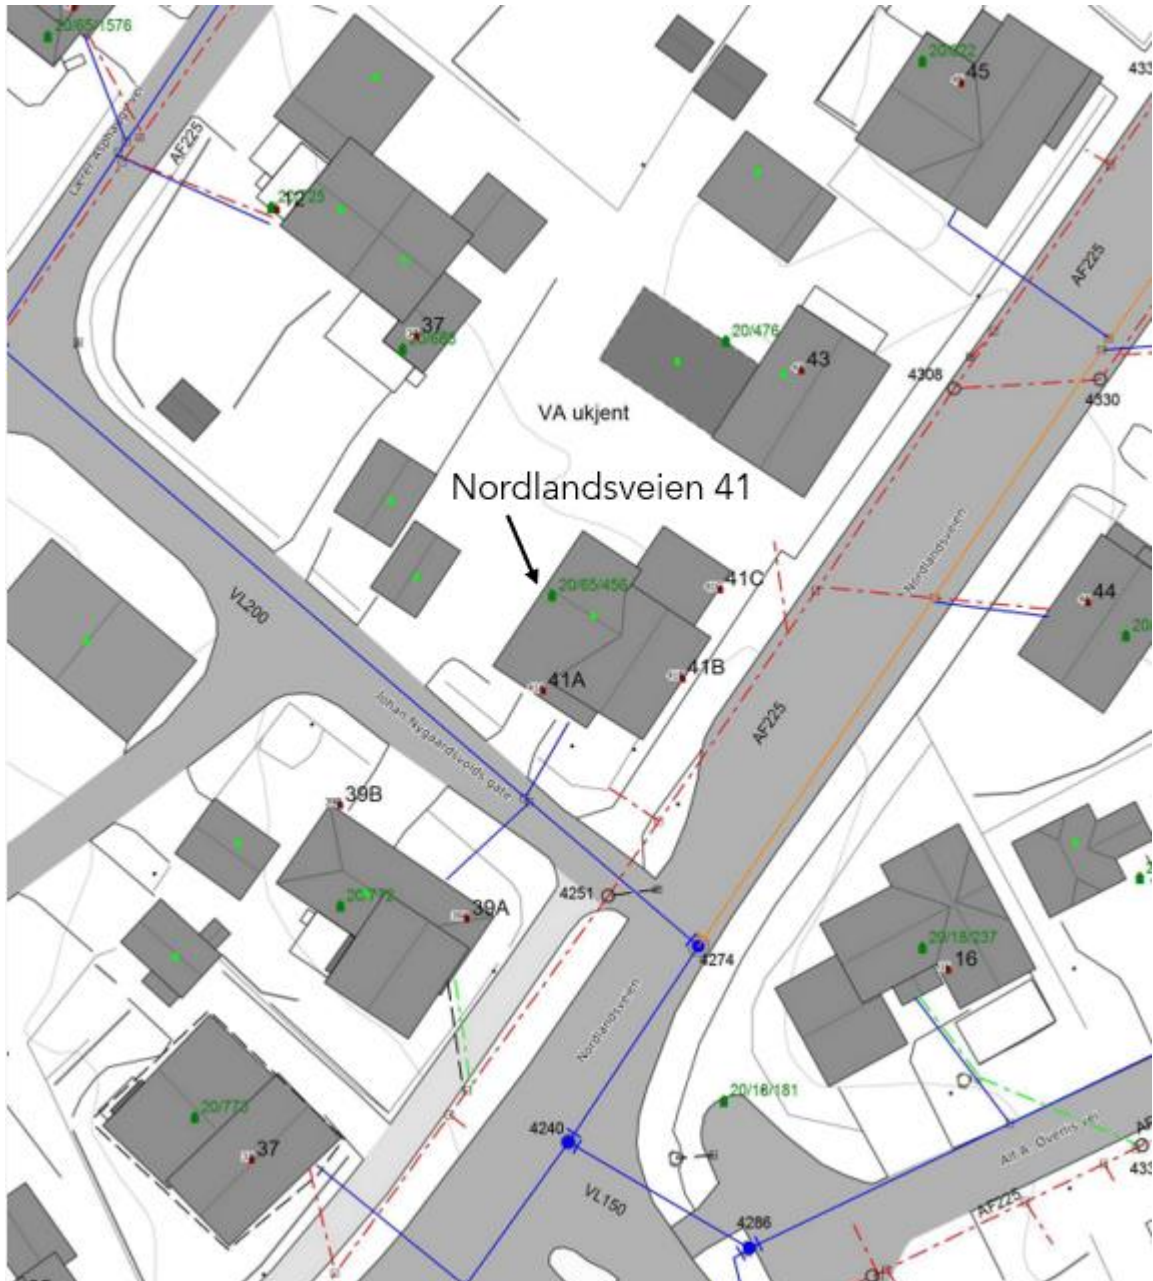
Situasjonsplan utomhus for planlagt byggetiltak. Kilde: Asplan Viak AS.
